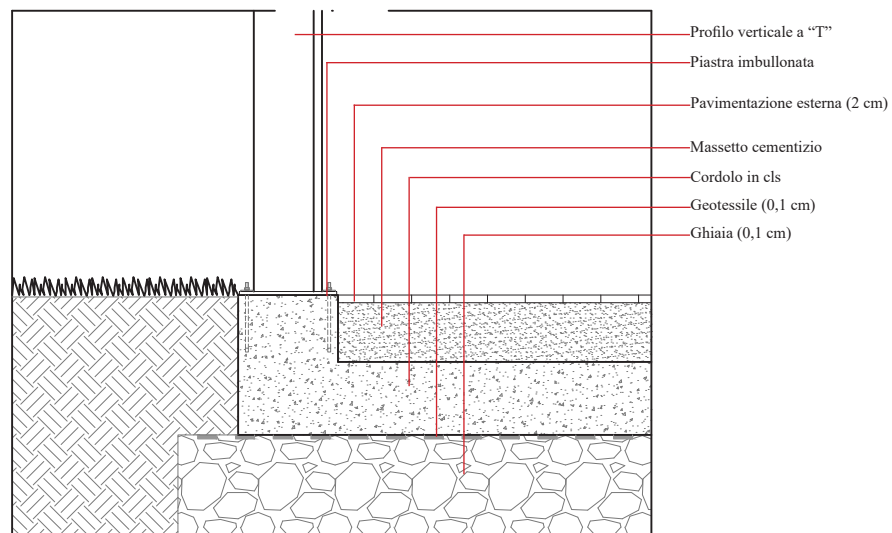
Dettaglio attacco a terra del supporto del balcone (scala 1:20).
